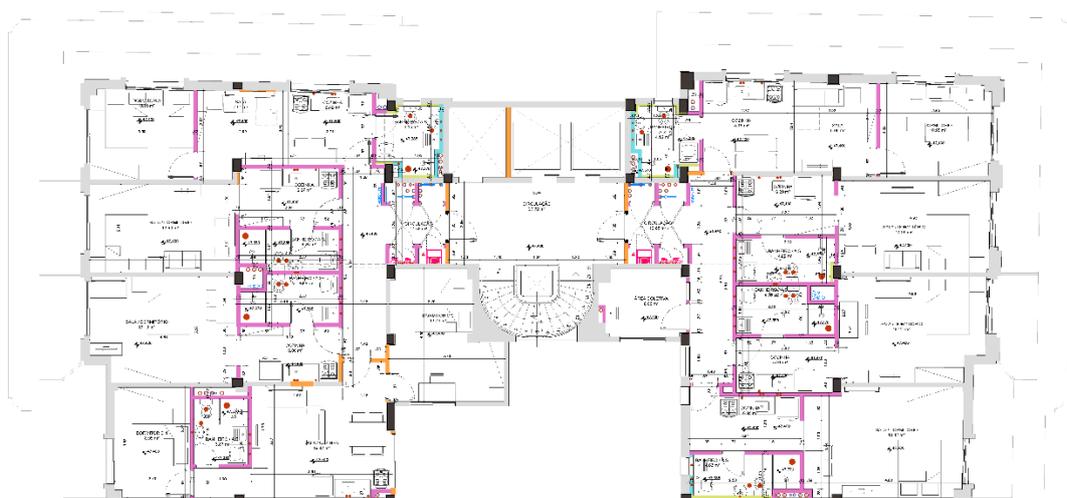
Planta tipo, projeto ATHIS. Fonte- ATHIS Peabiru
